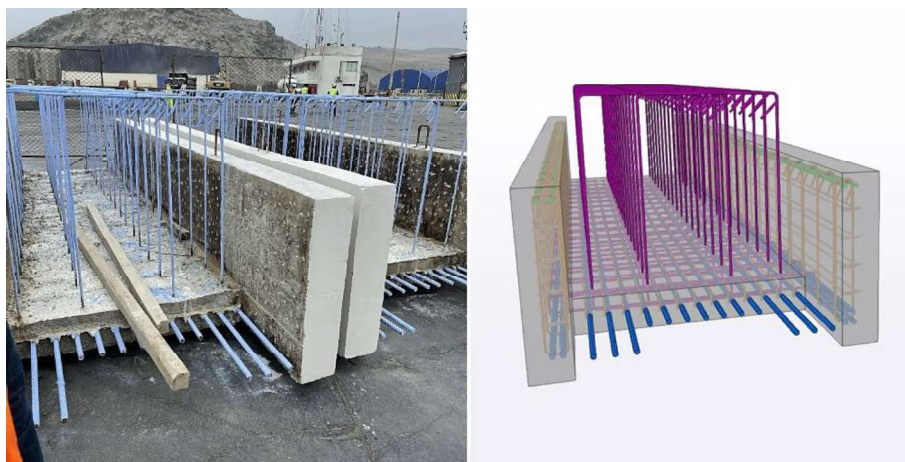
Vista frontal de prefabricado tipo viga. Elaboración propia-CRT
